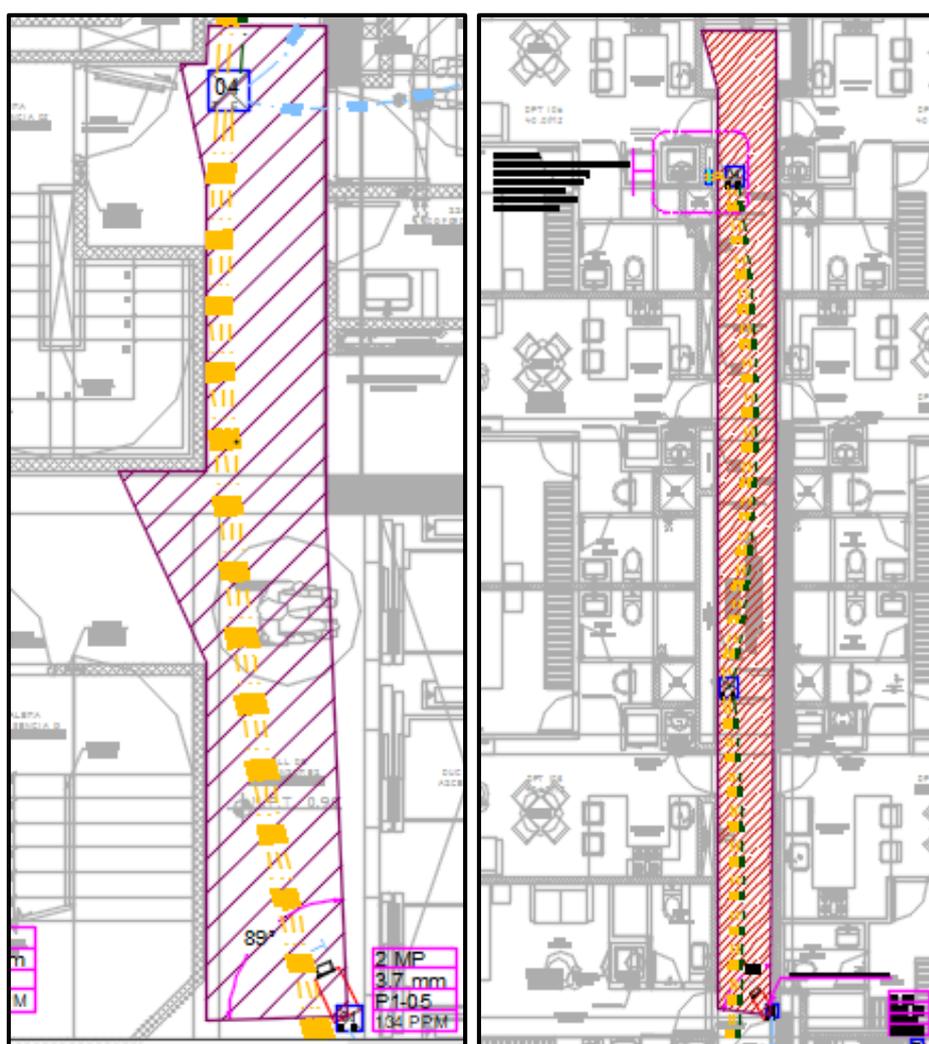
Ubicación de equipos en pasadizos del primer piso
